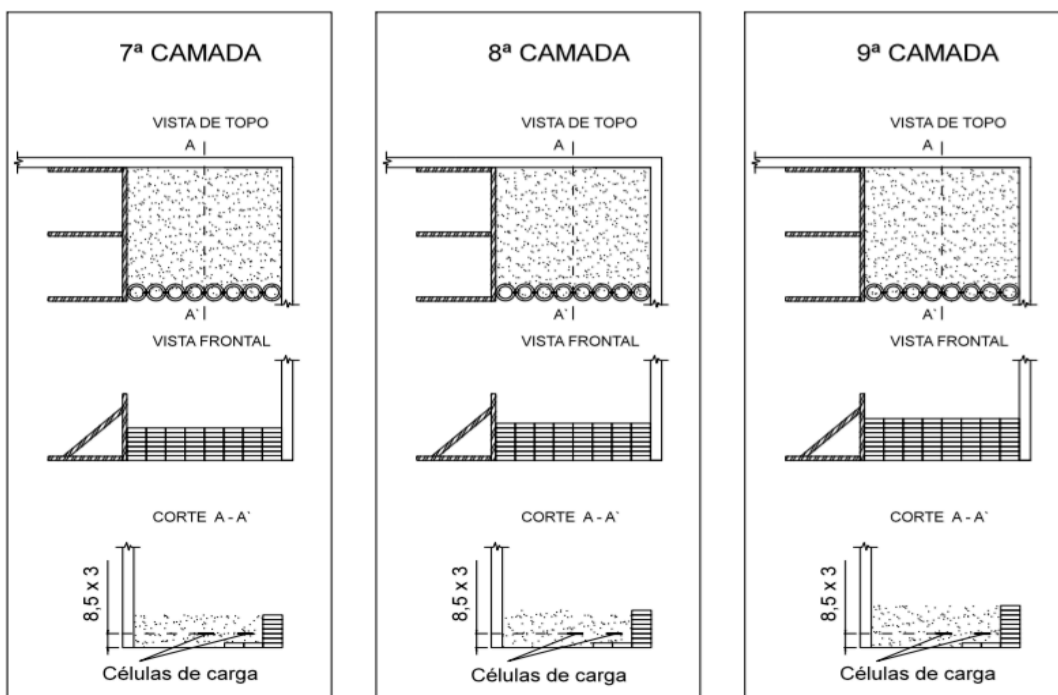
Faseamento construtivo da 7ª à 9ª camada.
